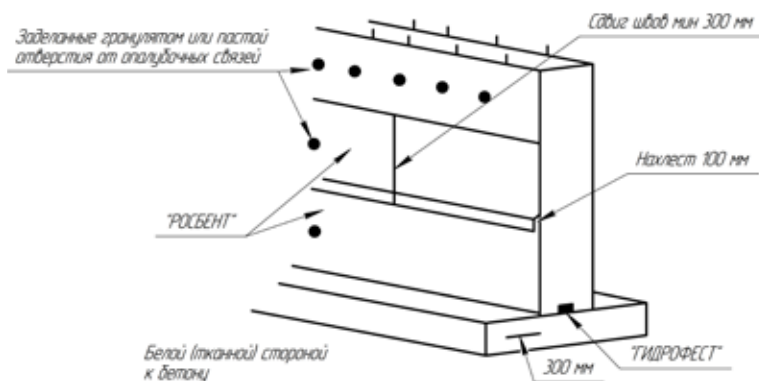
Укладка матов «Росбент» на вертикальную стену
